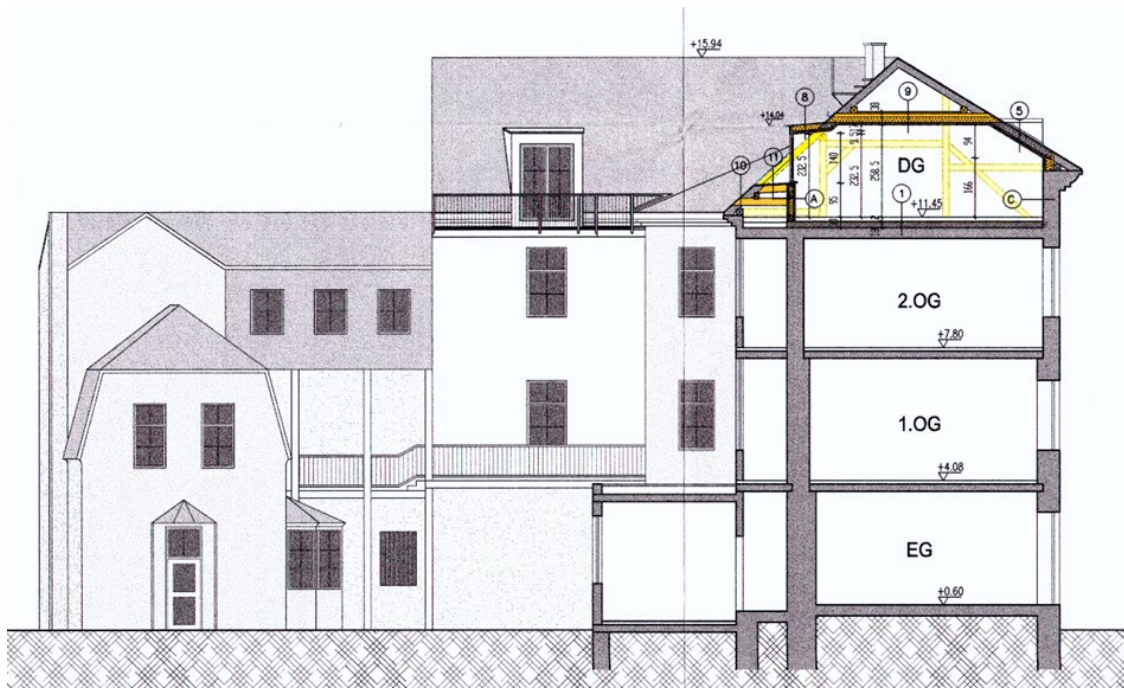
Schnitt (Einreichplan 03.12.2002)
